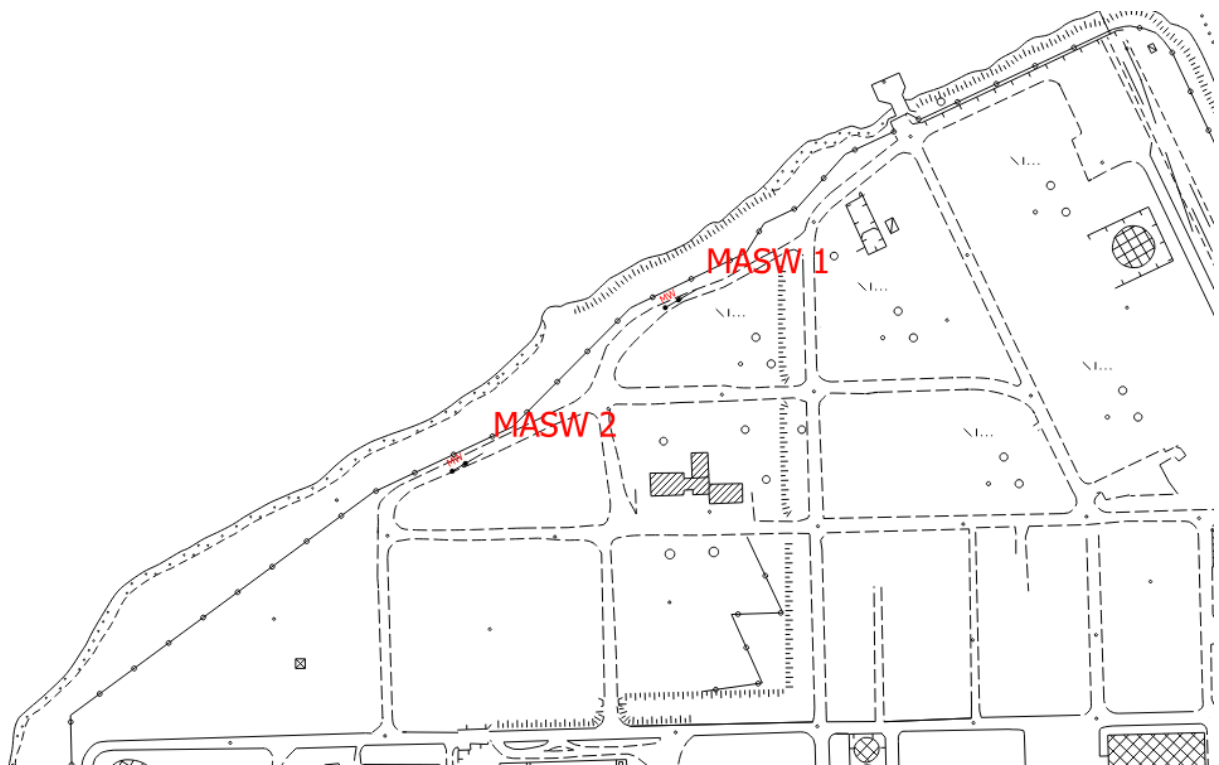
Estratto planimetrico non in scala riportante l'ubicazione delle prove MASW eseguite.
